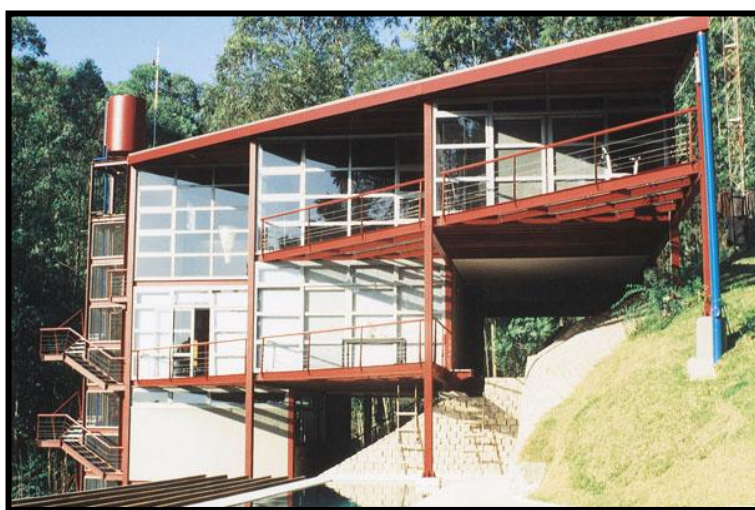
Sistema construtivo em estrutura metálica [5]
